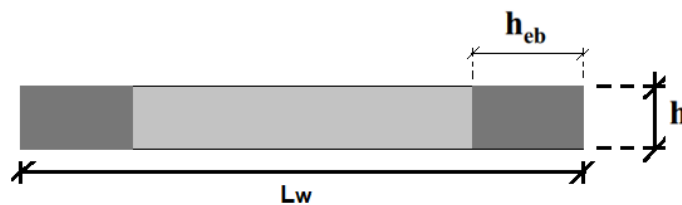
Ejemplo de muro estructural con elementos de borde.
